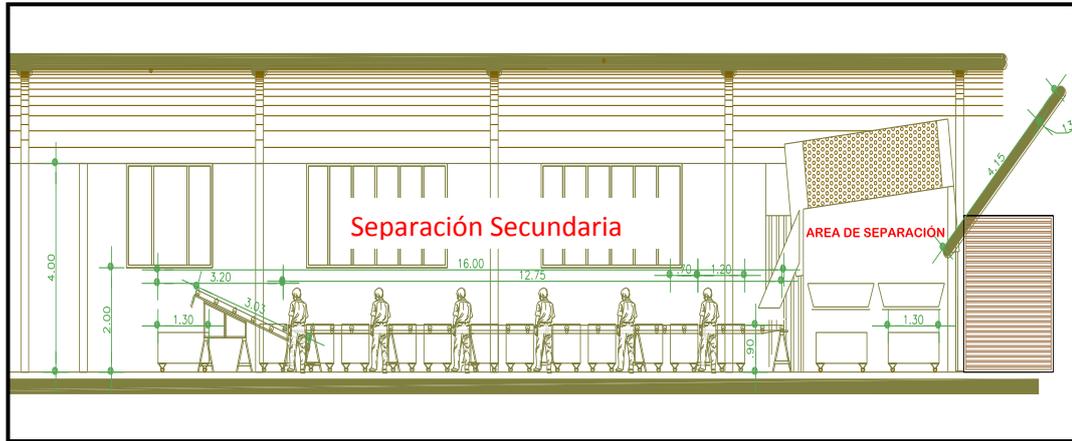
Vista arquitectónica general del área de separación secundaria de la planta de reciclaje
